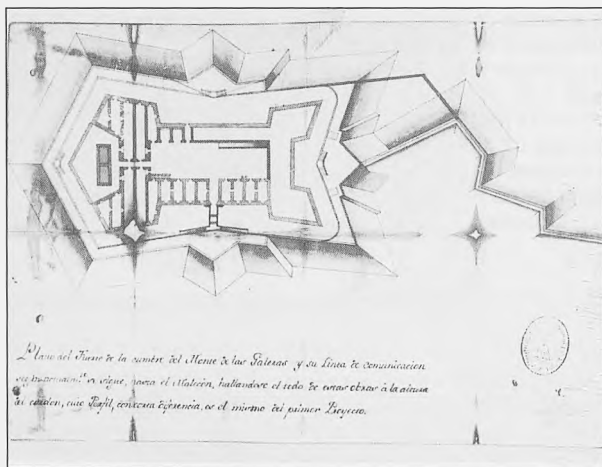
LLOBET, Francisco. Plano anónimo con las obras, habiendo alcanzado la altura del cordón. Posiblemente se trate de un plano de Mateo Vodopich que podría estar fechado en enero de 1776. SHM, sign 2652 (5)
